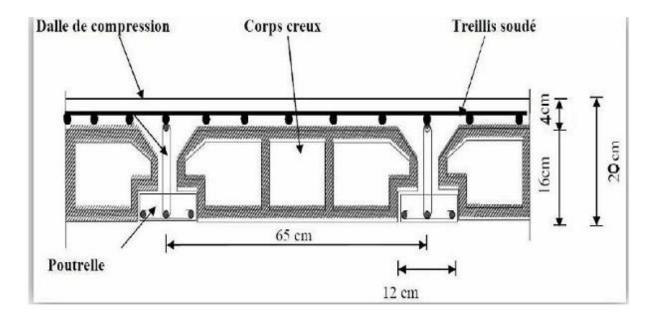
Schéma descriptif d'un plancher en corps creux
